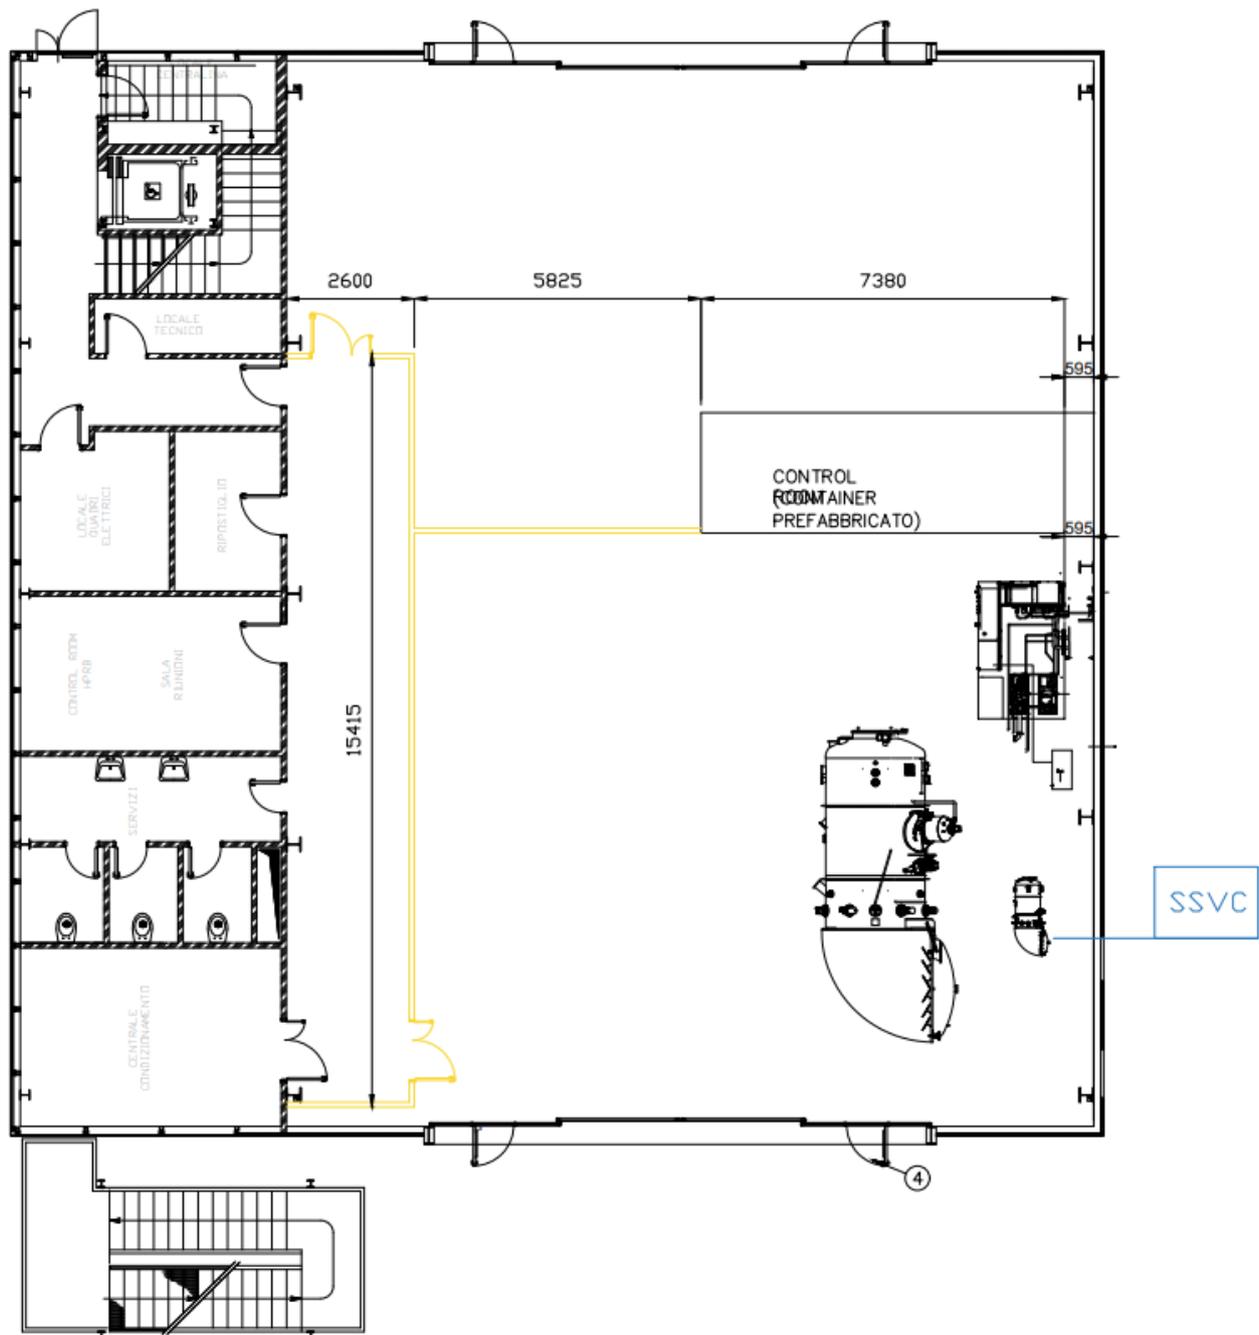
Planimetria dell'Hangar LISA e lay-out preliminare dell'Impianto MSVC con evidenziata l'allocazione di massima della camera SSVC
